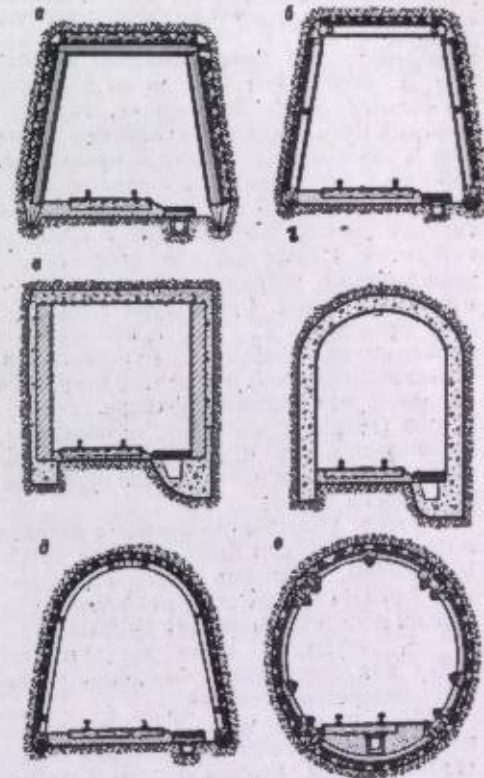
Формы поперечного сечения горизонтальных горных выработок: а и б — трапециевидная; в — прямоугольная; д и е — сводчатая; ж — круглая.
